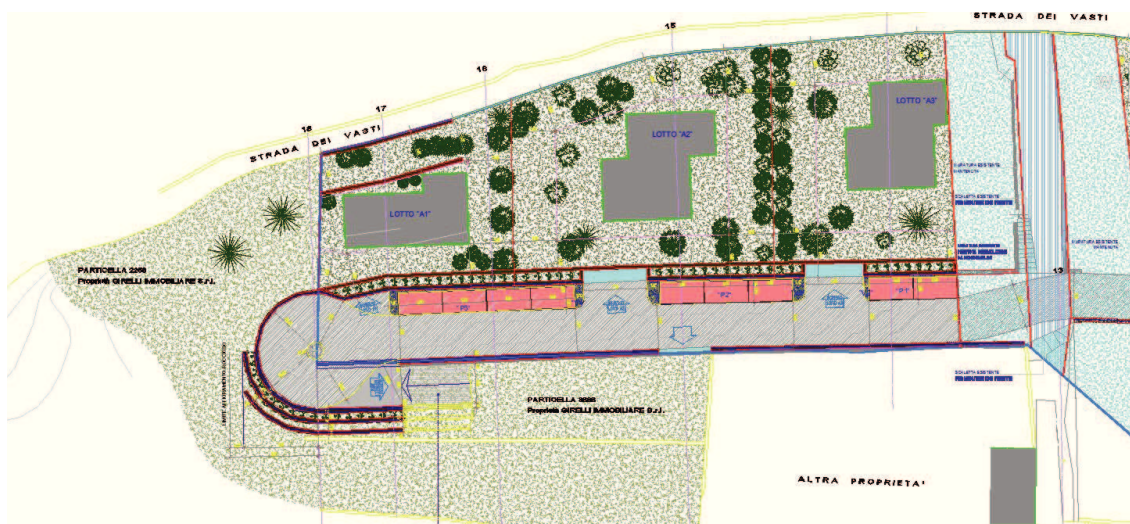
Planimetria di progetto - stralcio (da Studio geom. Cancelli)
